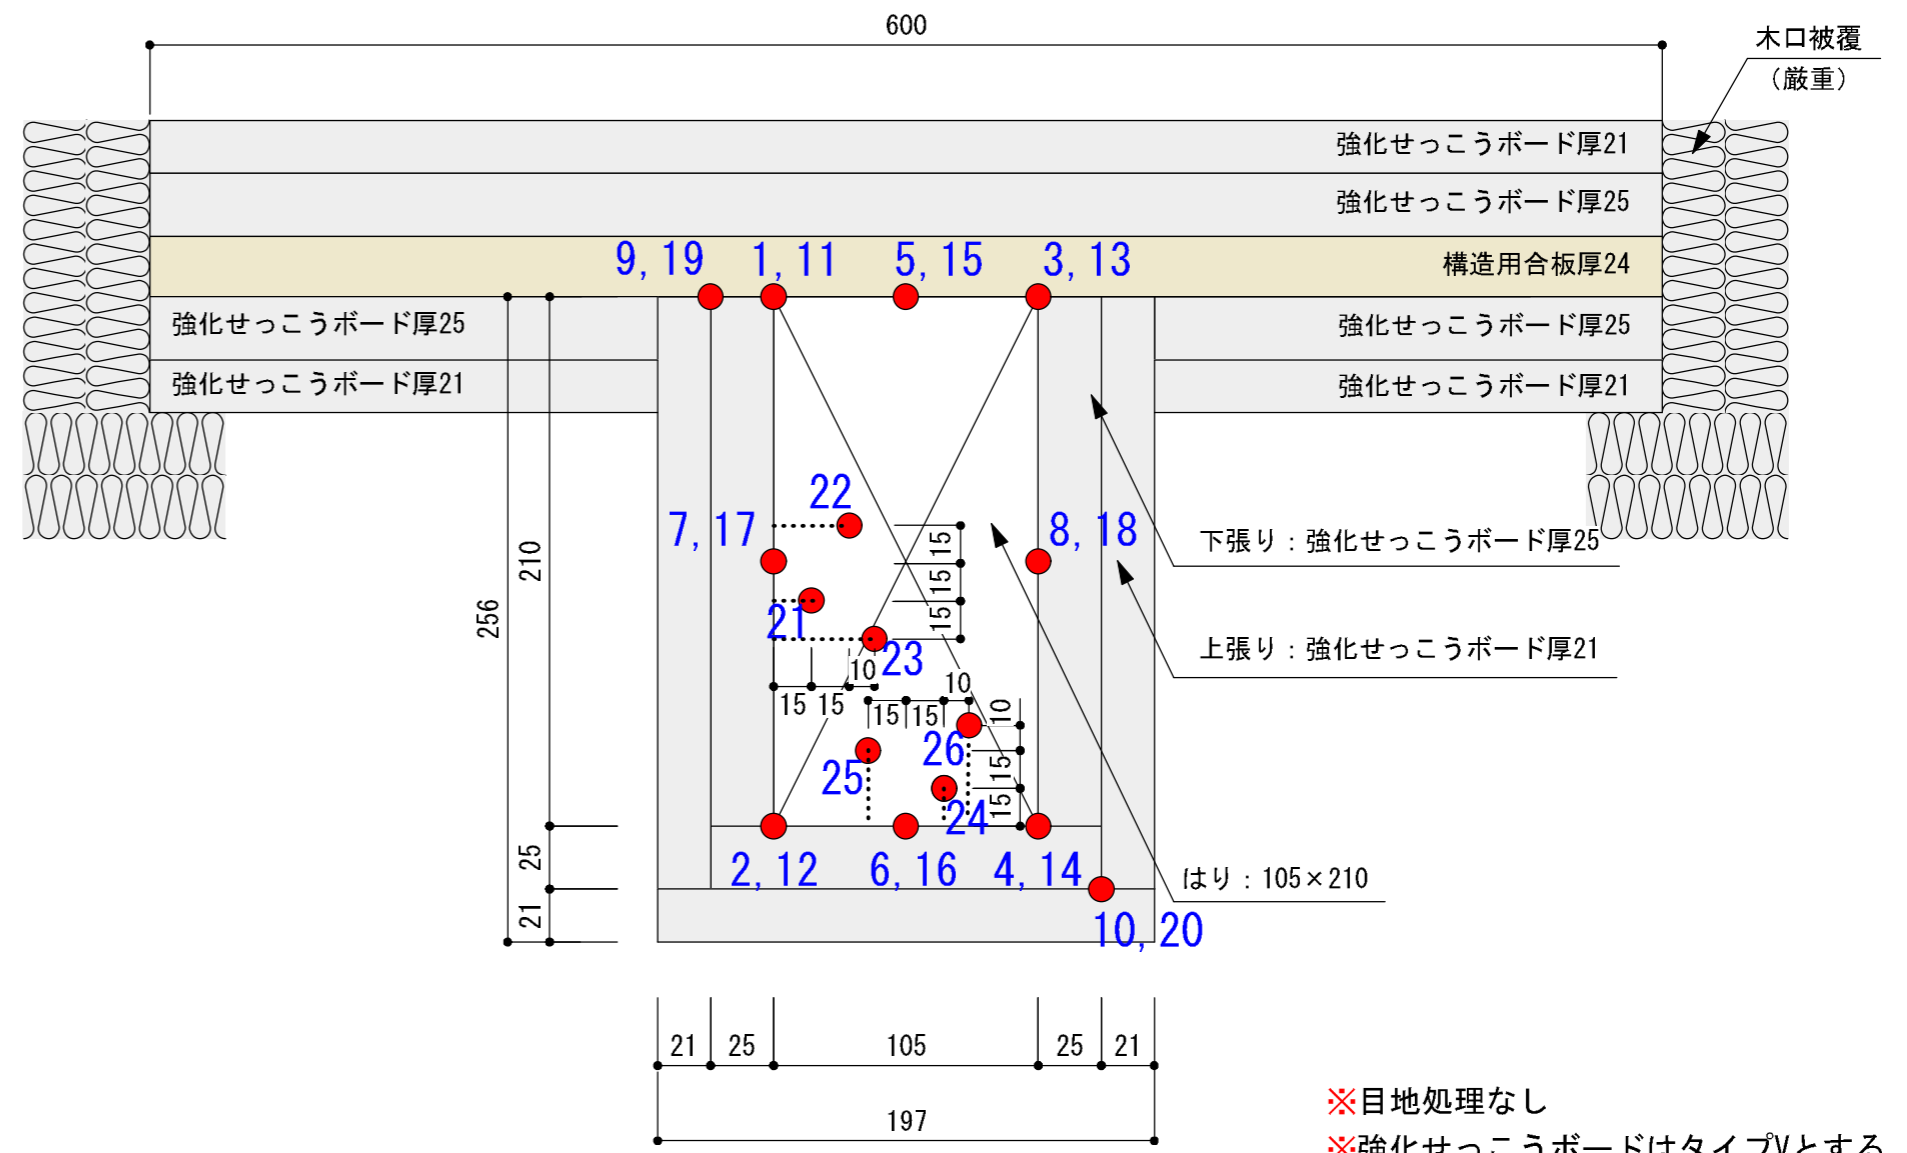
木造梁耐火試験用試験体 割付図 (寸法:mm)
